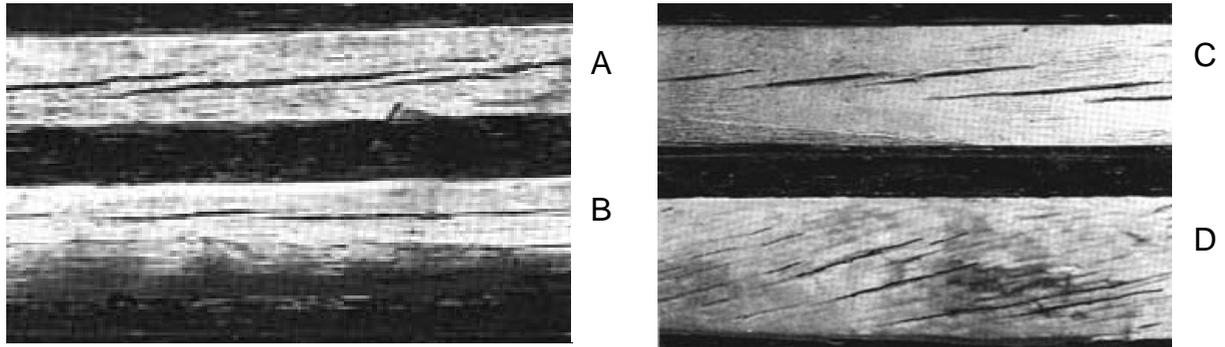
TRAVES SECAS FISSURAS DE CONTRAÇÃO,
